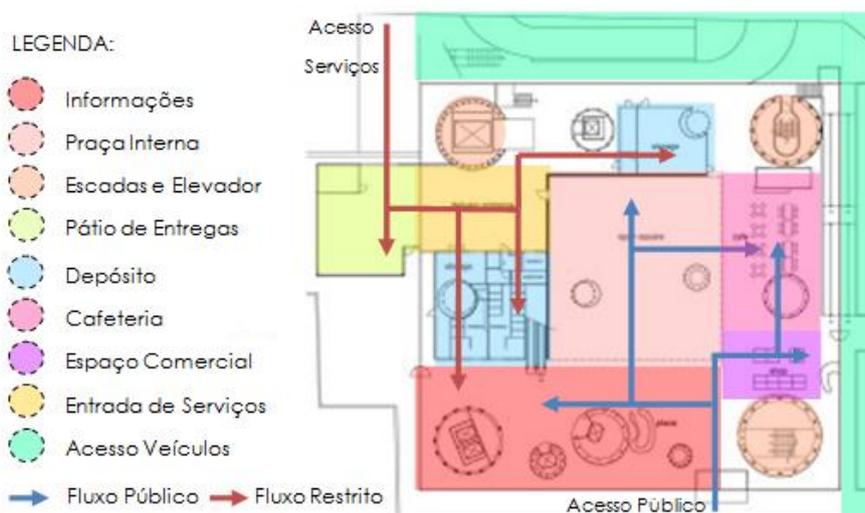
PLANTA PAVIMENTO TÉRREO: FUNÇÕES E FLUXOS
